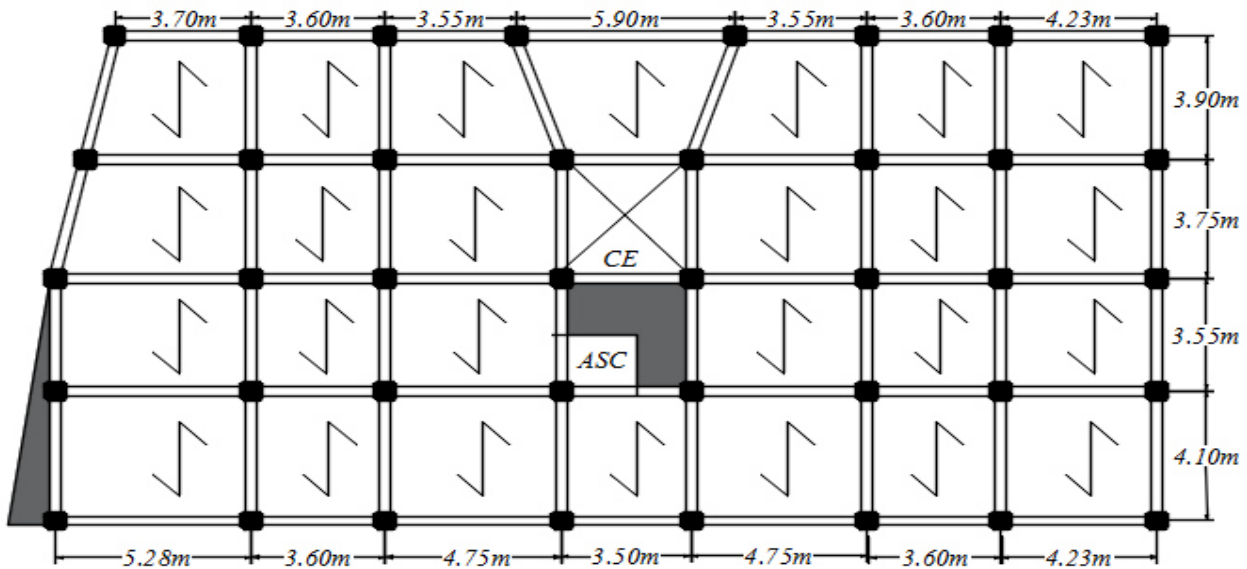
Disposition des poutrelles du RDC au 8ème étage
